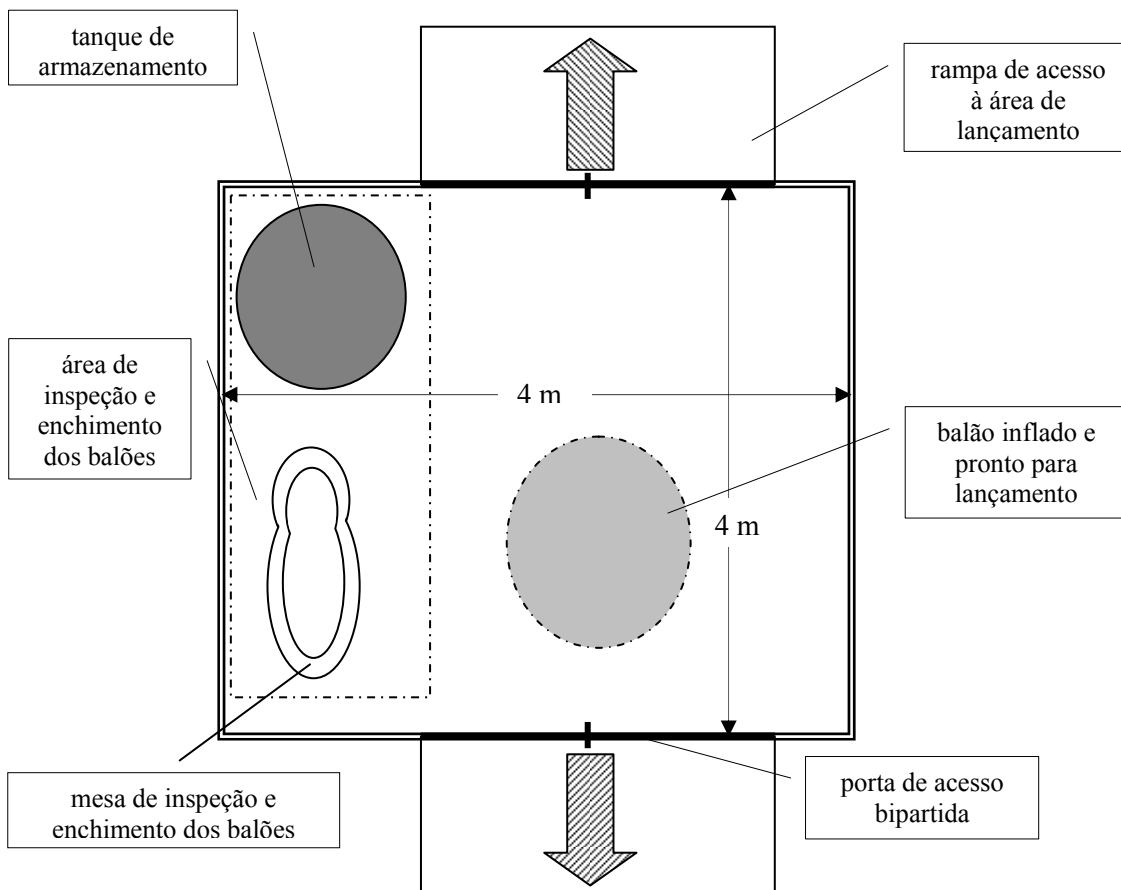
Sugestão de planta para o módulo de armazenamento e enchimento de balões
